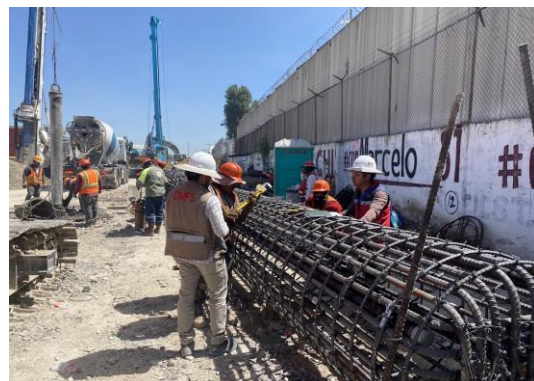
y 183 Autoría Propia (2023) "Verificación de espaciamientos y conectores mecánicos en pilas de más de 20 metros de longitud"
